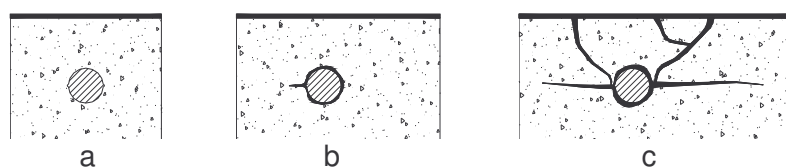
Fissuração/destacamento do betão devido à corrosão das armaduras
